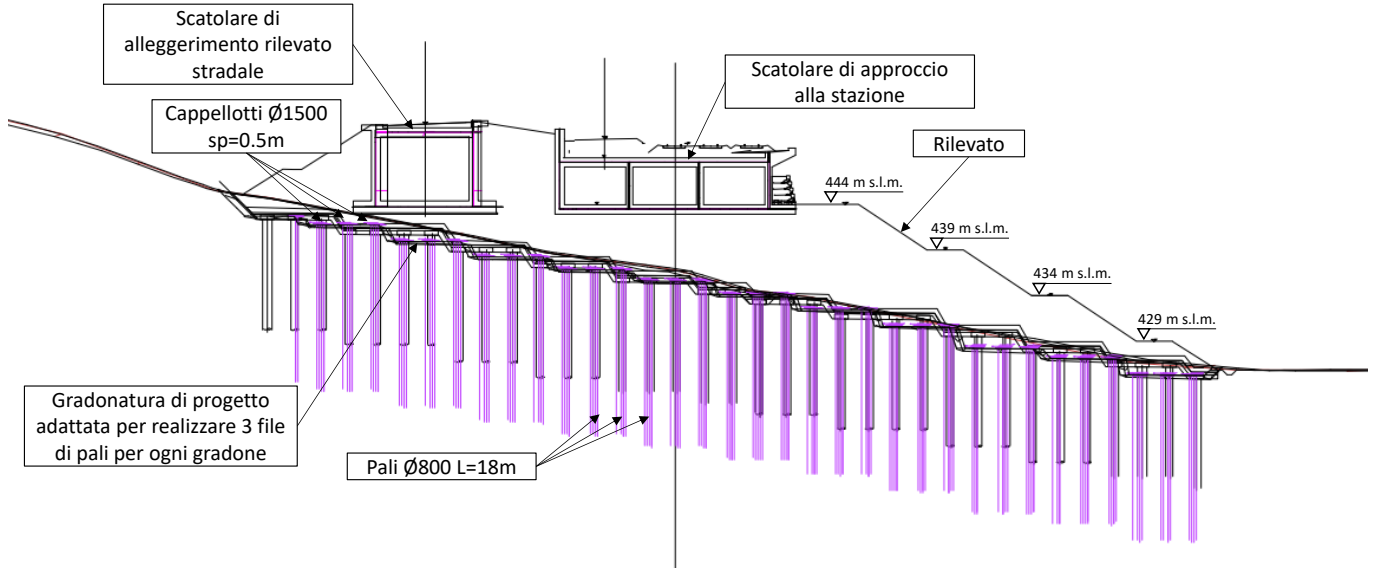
Sezione 14. Sovrapposizione tra sezione di progetto e porzione di geometria implementata nel modello
